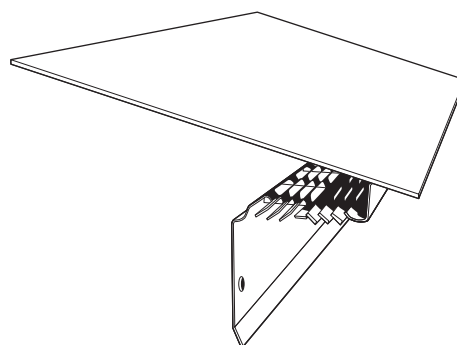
А. При монтаже на дома без софитов вентилируемый капельник сочетается в себе капельник с входными жалюзийными отверстиями.
